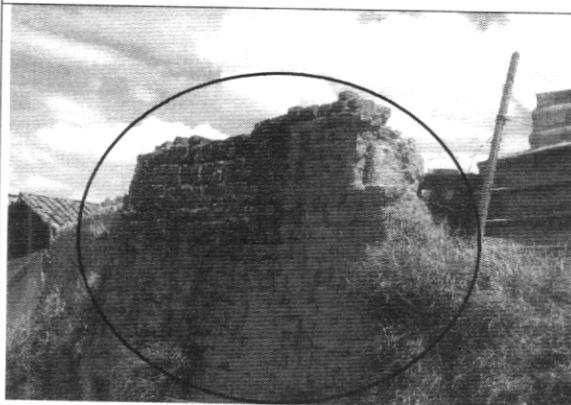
Pérdida de verticalidad en la zona central del muro del costado sur
